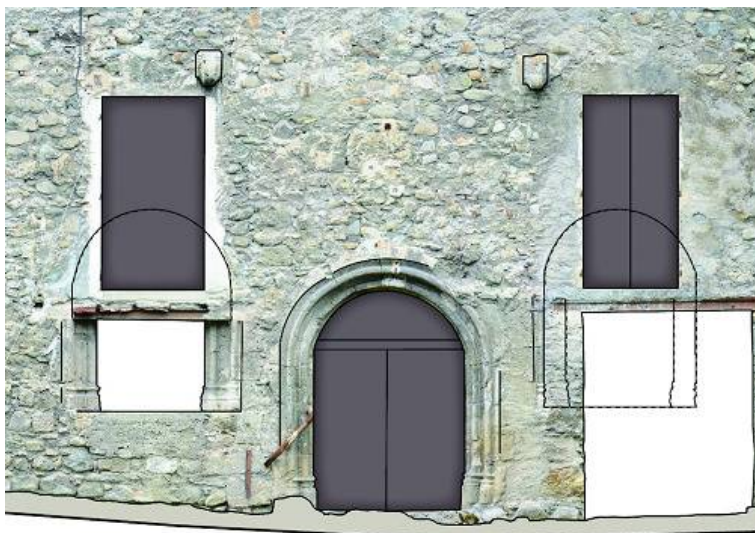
Salle capitulaire, façade sud, baies à restituer (en pointillé)
